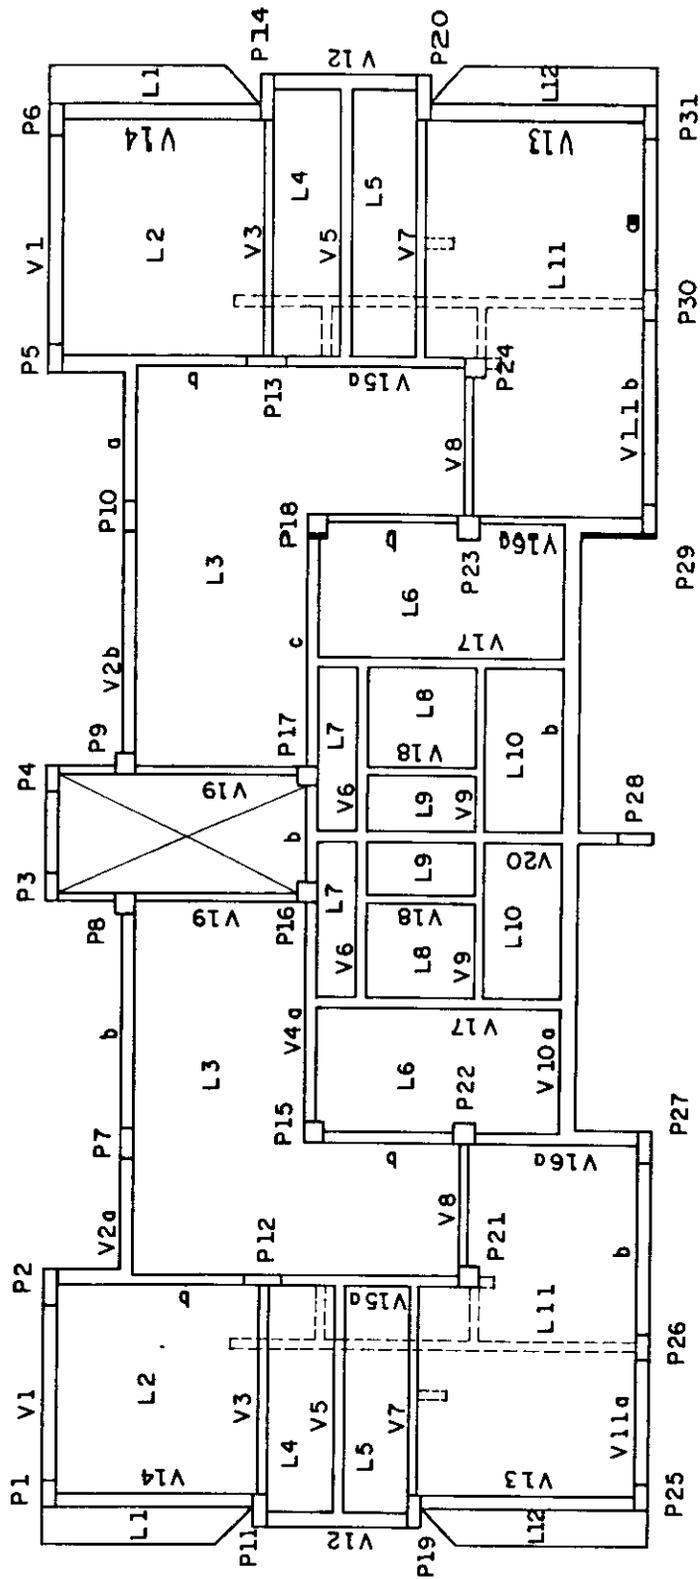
Estrutura IV - Pavimento Tipo Edifício B
